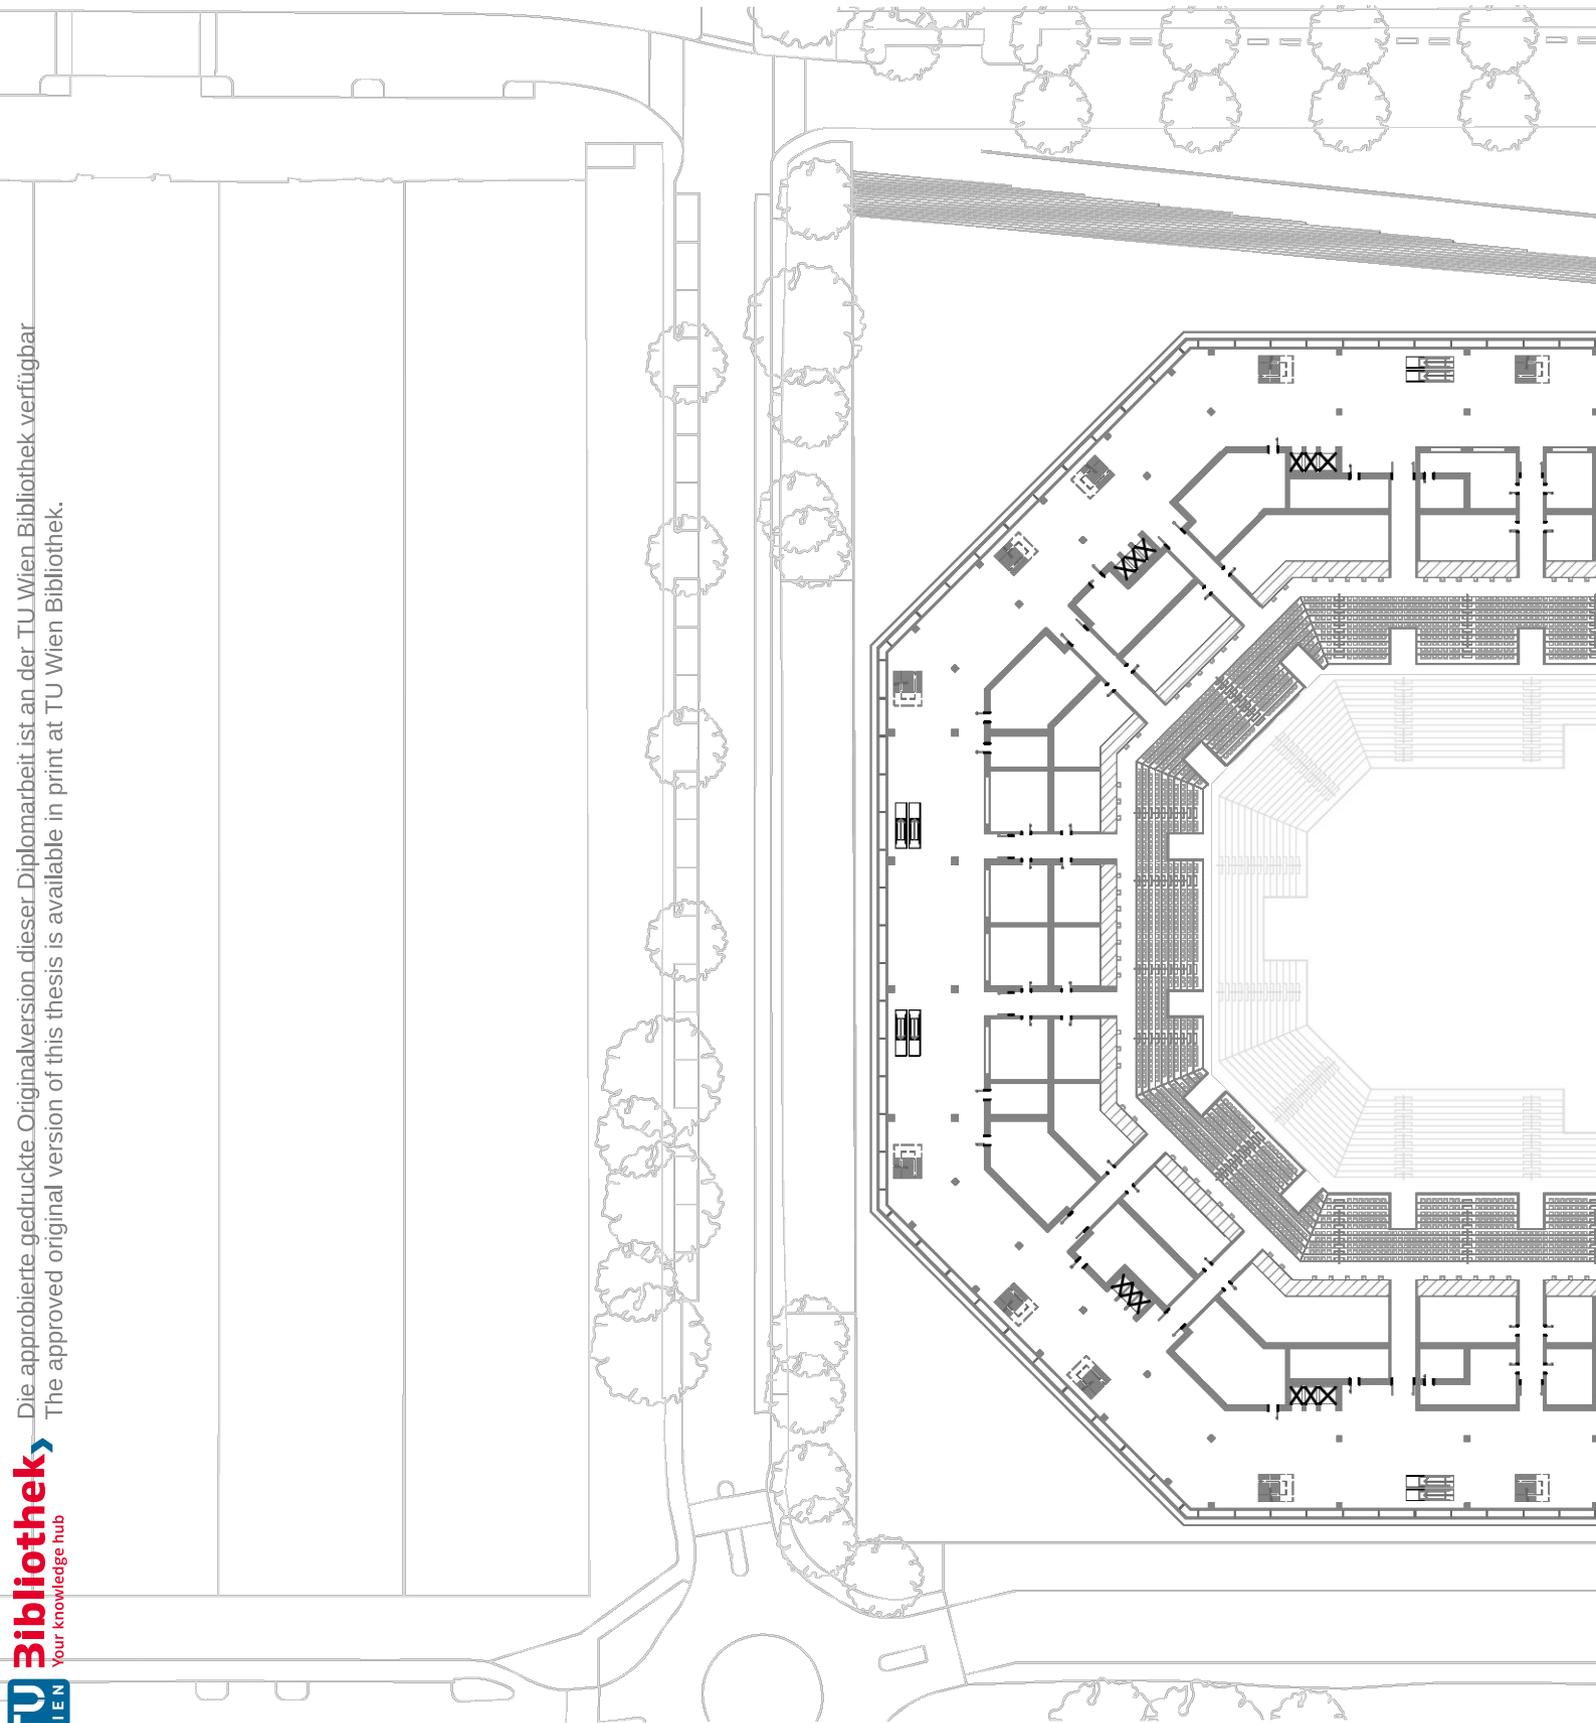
Grundriss 1. OG Zoom Terrasse
